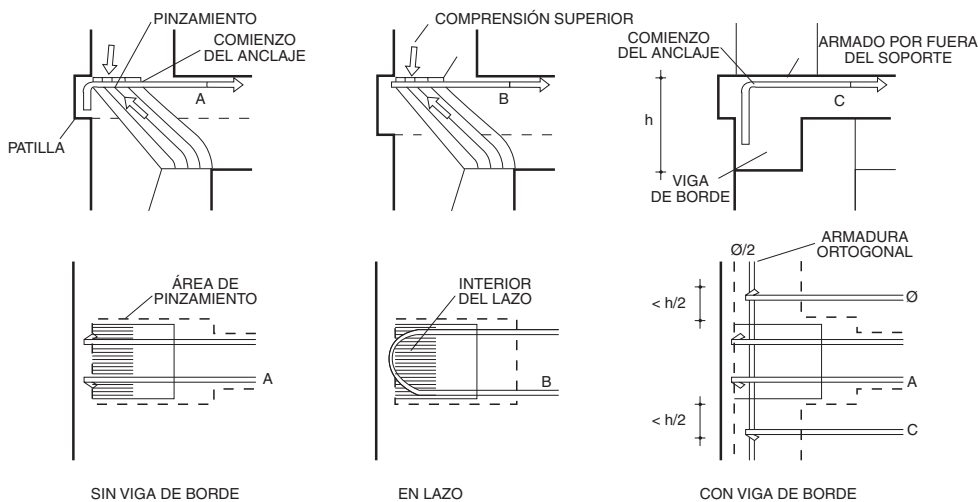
Armaduras superiores en nudo extremo con soporte de hormigón
